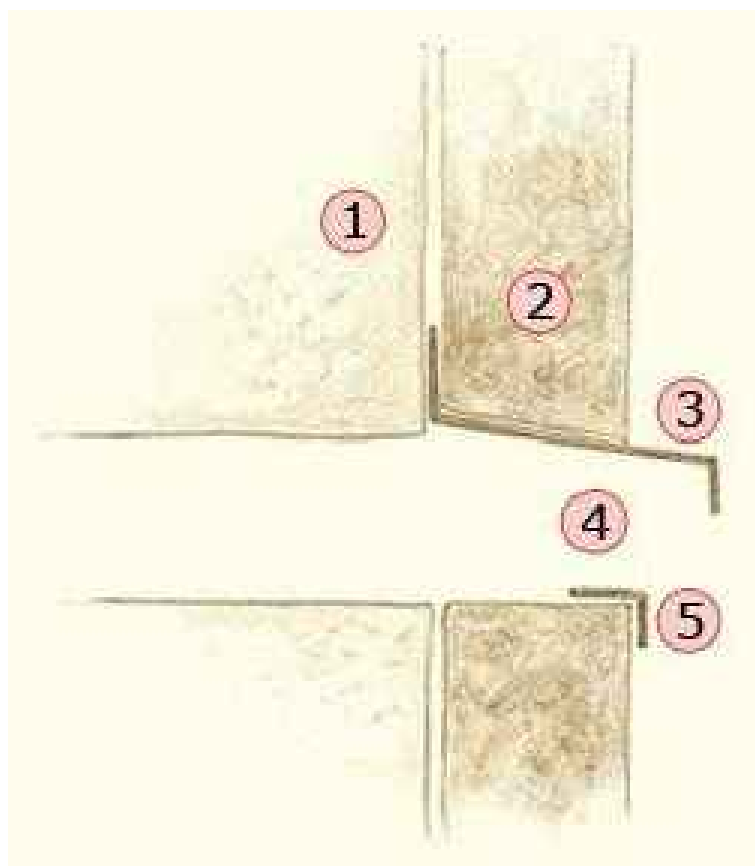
DETAIL ZESÍLENÍ U OKENNÍHO OTVORU
